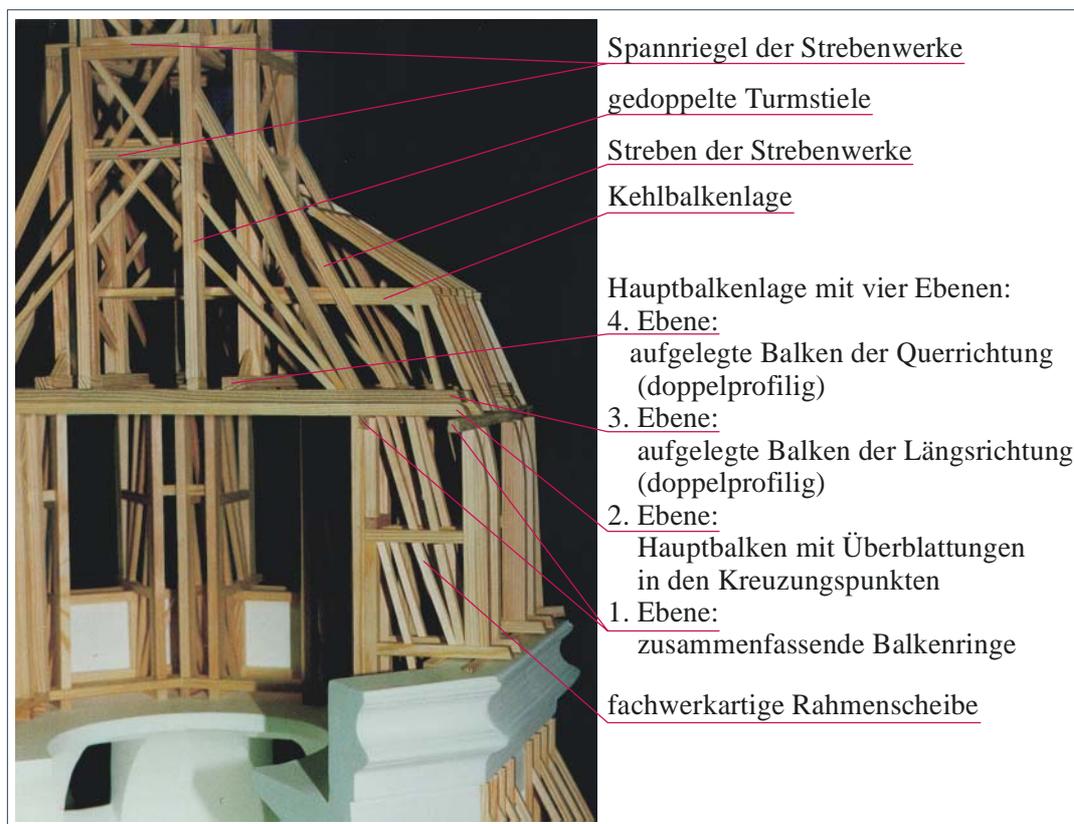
Fachwerkartige Rahmenscheibe mit Hauptbalkenlage und Strebenwerken.
